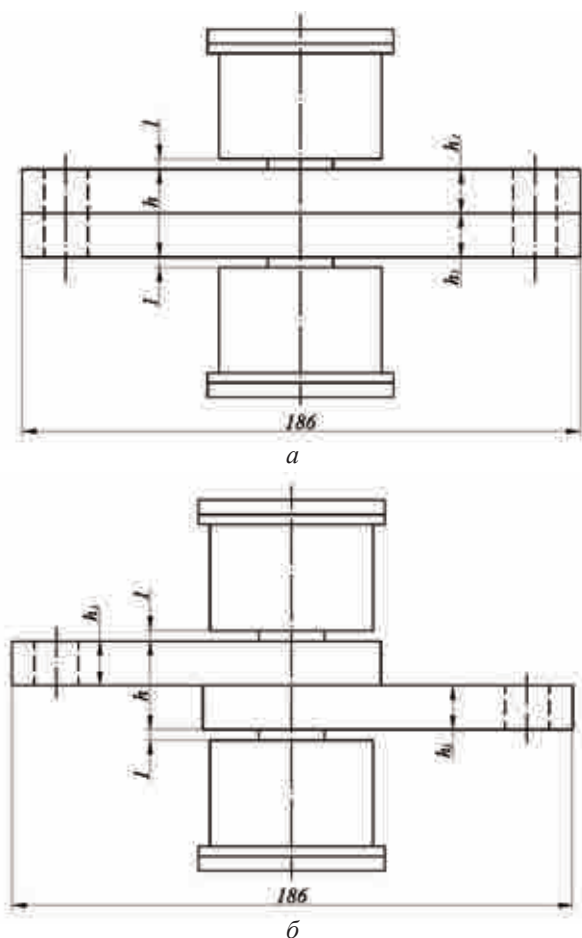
Образцы соединений с тензометрическими втулками для замера усилий стяжки пакета:
